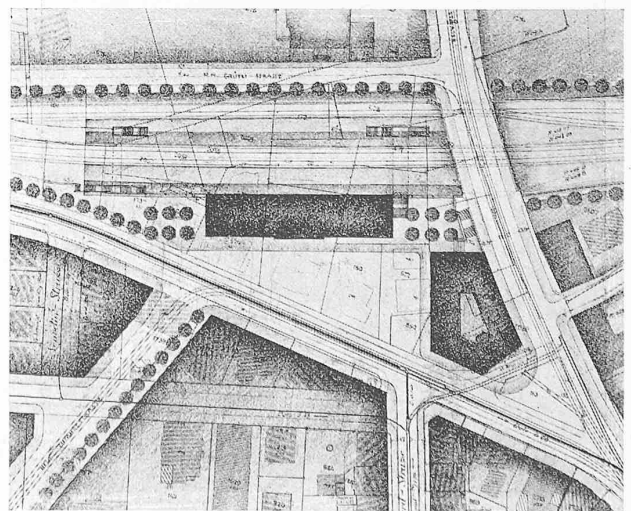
Entwurf Nr. 1. Arch. Alb. Frölich. — Lageplan 1 : 2500.
